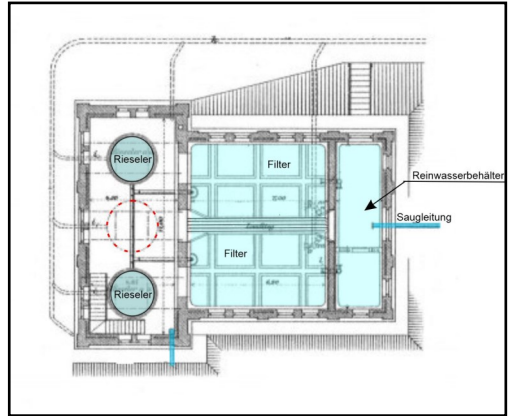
Enteisungsanlage mit Rieselern und Filtern im Grundriss.
